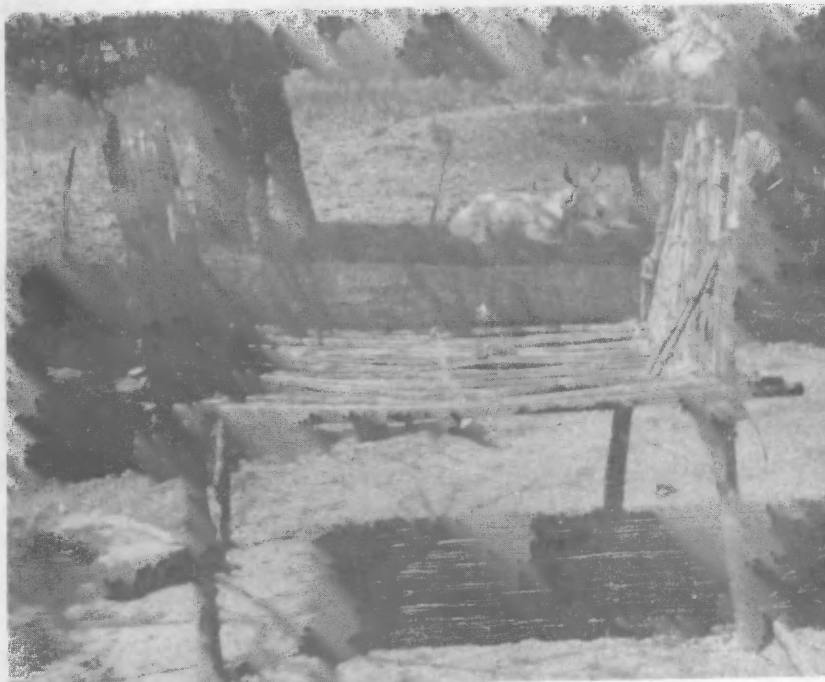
Varas delgadas de bambú utilizadas para construir ca-
